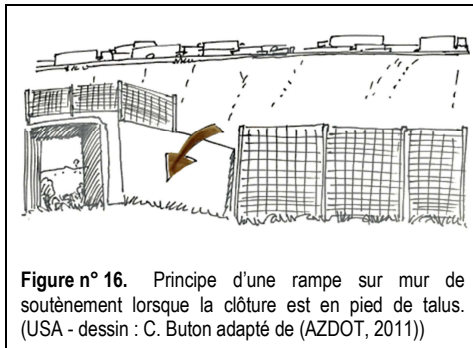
Principe d'une rampe sur mur de soutènement lorsque la clôture est en pied de talus. (USA - dessin : C. Buton adapté de (AZDOT, 2011))
